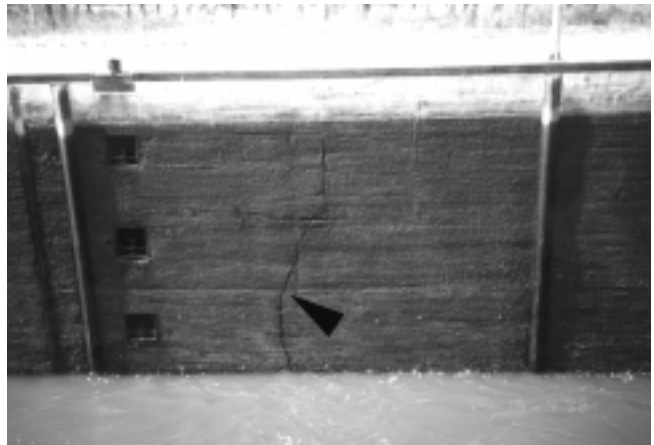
Senkrechter Trennriss an einer Schleusenkammerwand aus Stahlbeton
